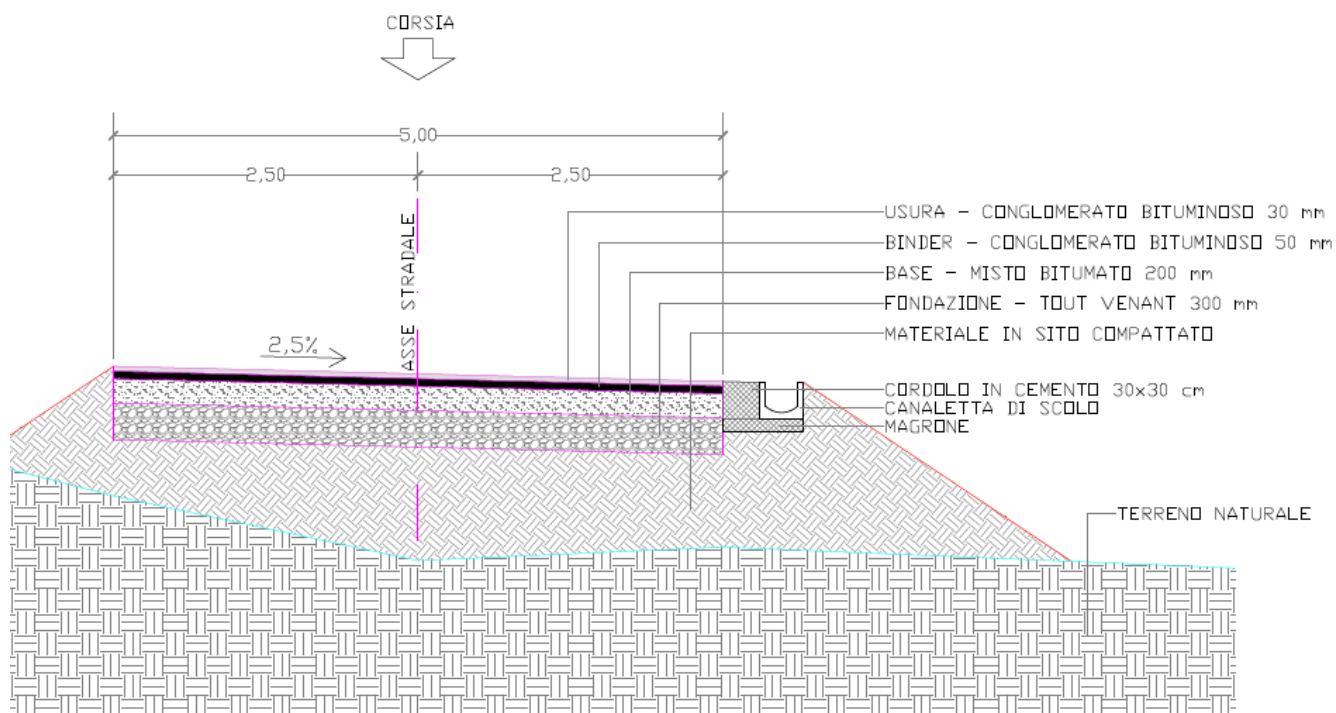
Estratto Tavola 23_Tav12C. Particolare Sezione strada di coronamento
